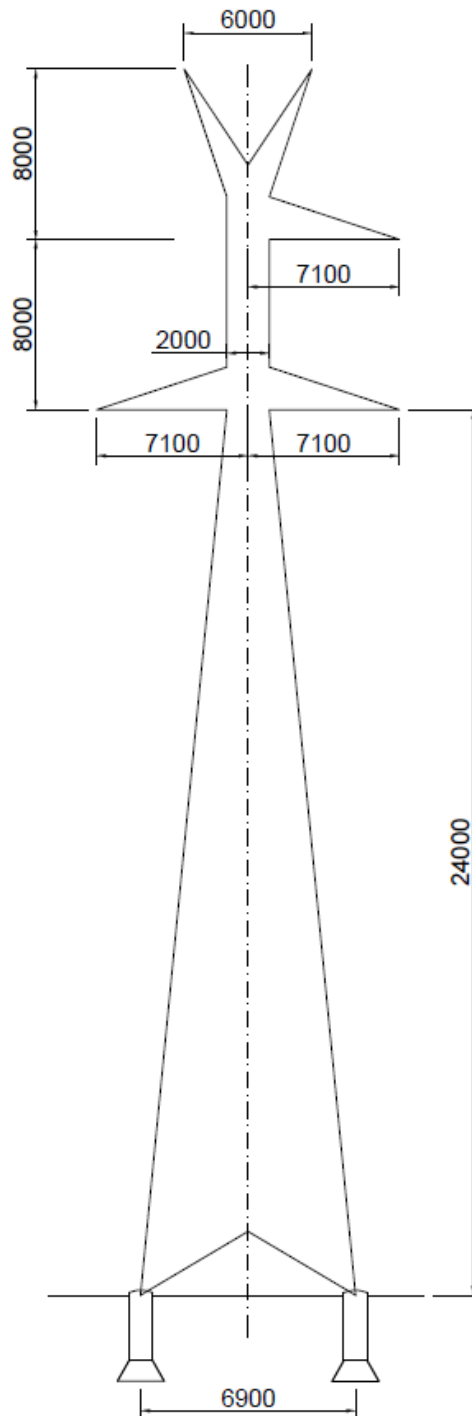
Apoyo TORNADO 400-A2HaFL 24 (apoyo nº 4)
